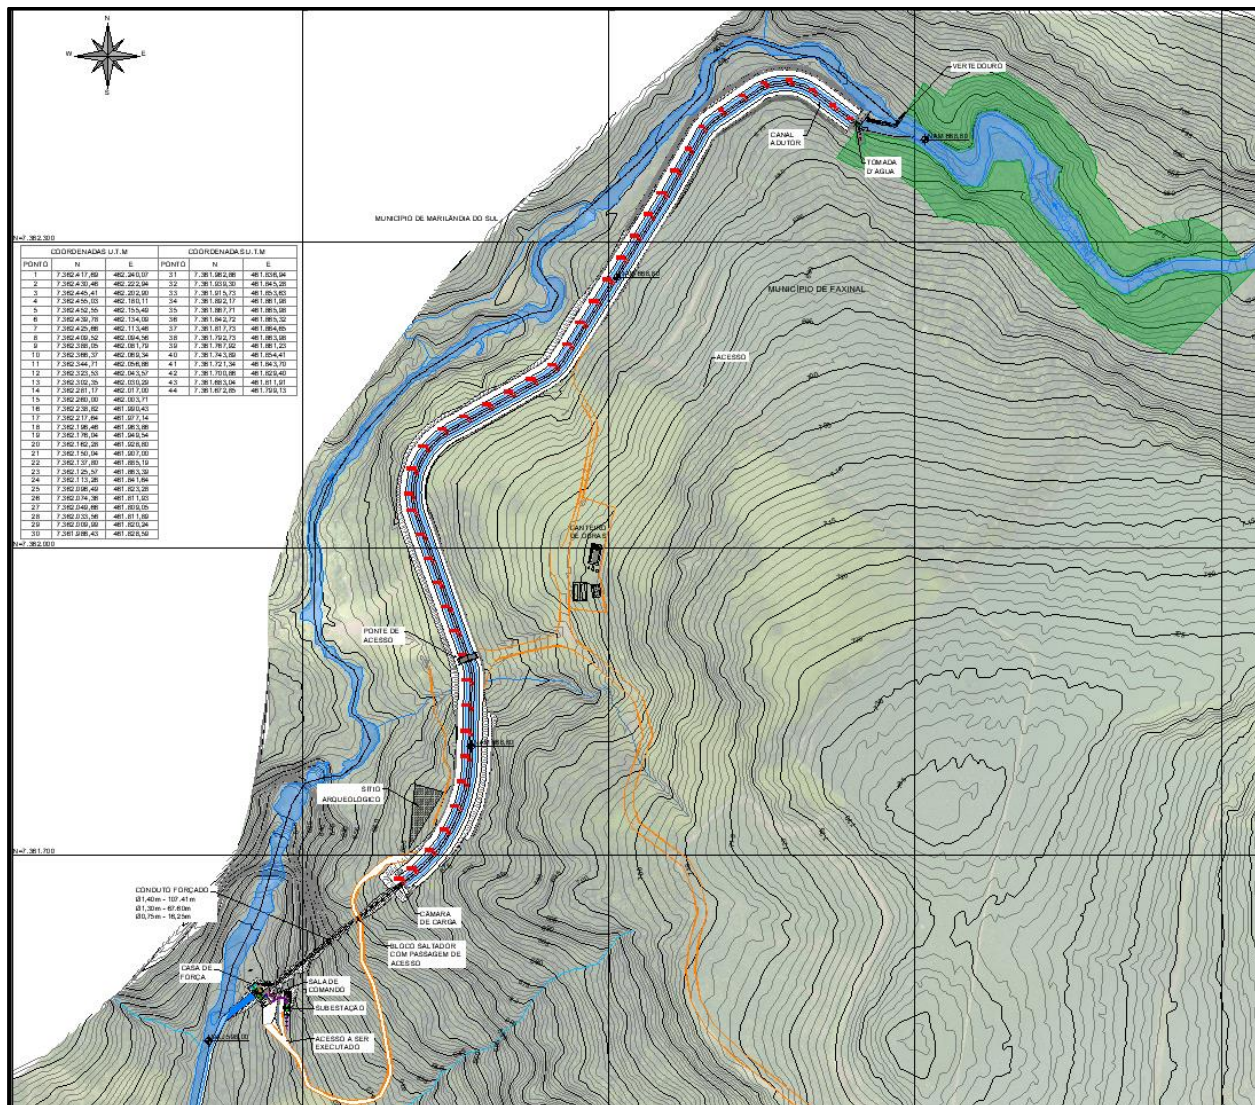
Projeto executivo arranjo geral do empreendimento.
